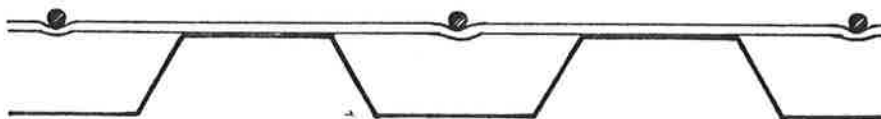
Interação entre armaduras adicionais transversais e longitudinais.
